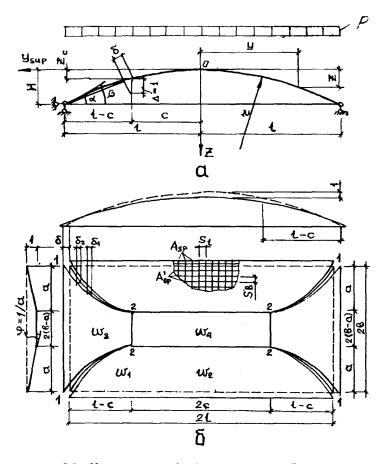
К расчету гибкой плиты-пологой цилиндрической оболочки а-геометрические параметры конструкции; б-схема разрушения и виртуальные перемещения жестких дисков оболочки
